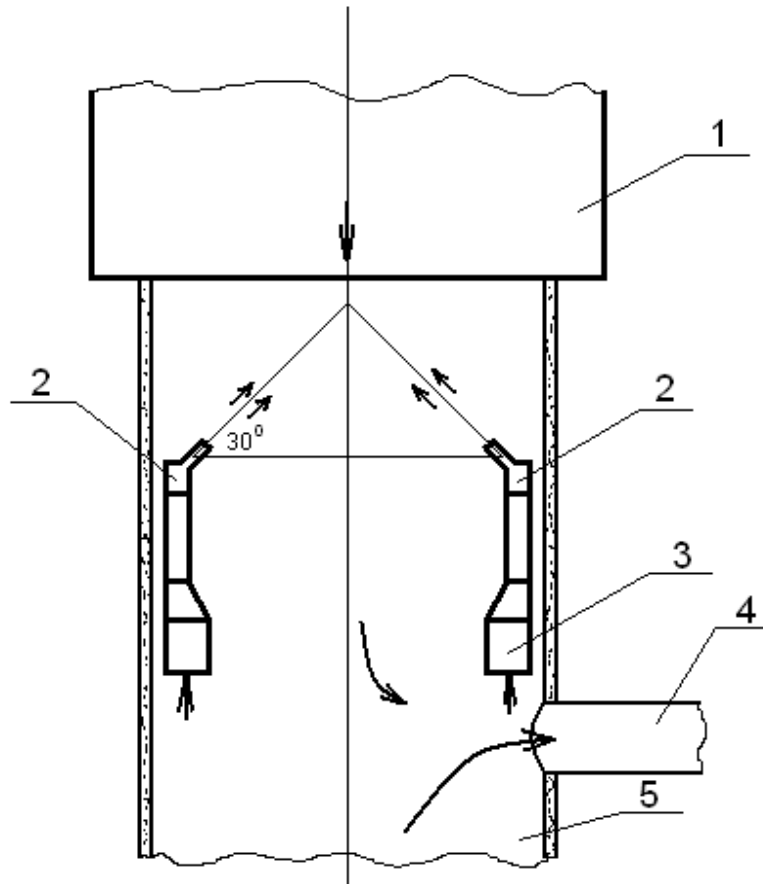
Схема расположения вентиляторной установки САУ в стволе: 1 – надшахтное здание; 2 – устройство равномерной раздачи воздуха; 3 – вентиляторы САУ; 4 – канал вентилятора; 5 – вентиляционный ствол.
